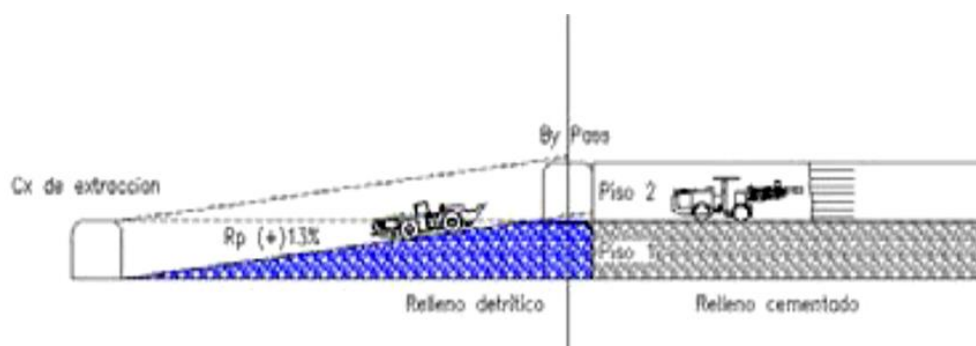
Vista lateral del relleno en un rebaje. (Agama, 2022)
